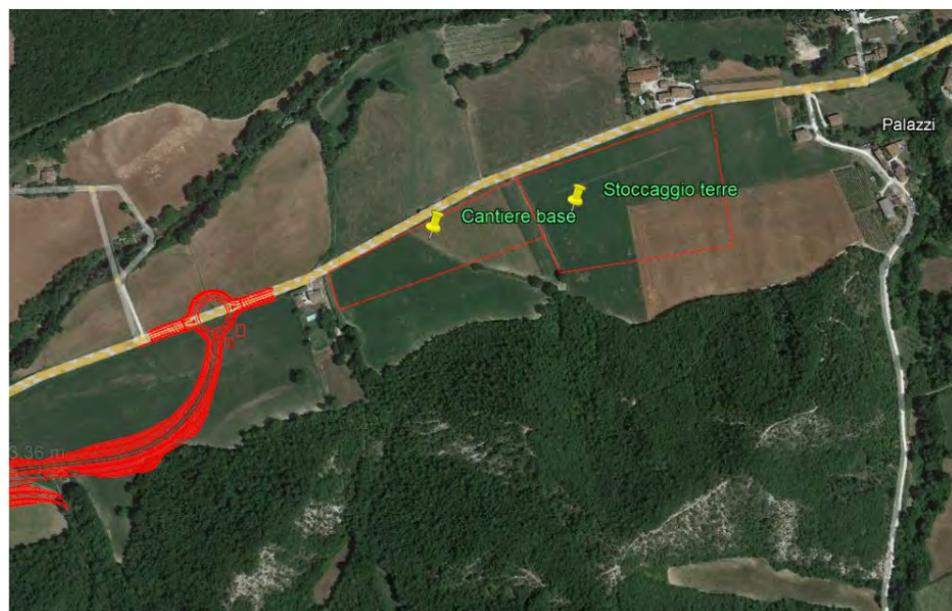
Ubicazione su ortofoto parte finale del tracciato di progetto, Cantiere Base e Zona di stoccaggio terre
